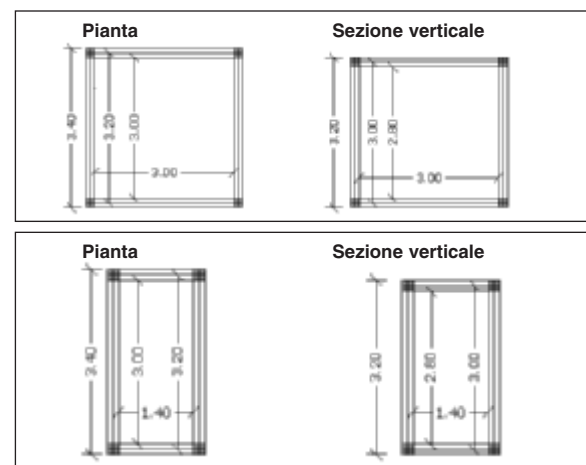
Sezione verticale e orizzontale del modulo e del mezzo.
